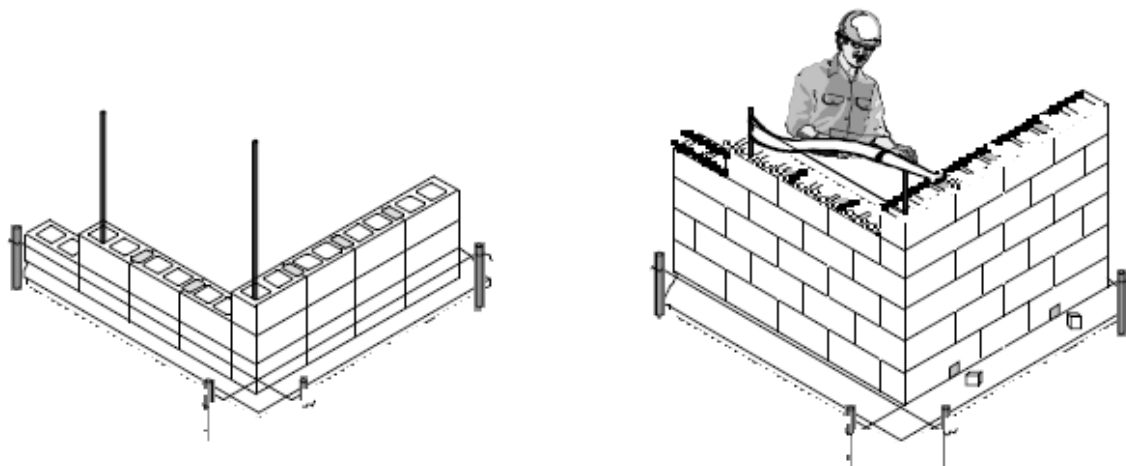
Detalle de construcción en muros en mampostería reforzada. Fuente: <https://sites.google.com/site/cydenvis/4criterios-1/sistemas-constructivos>
